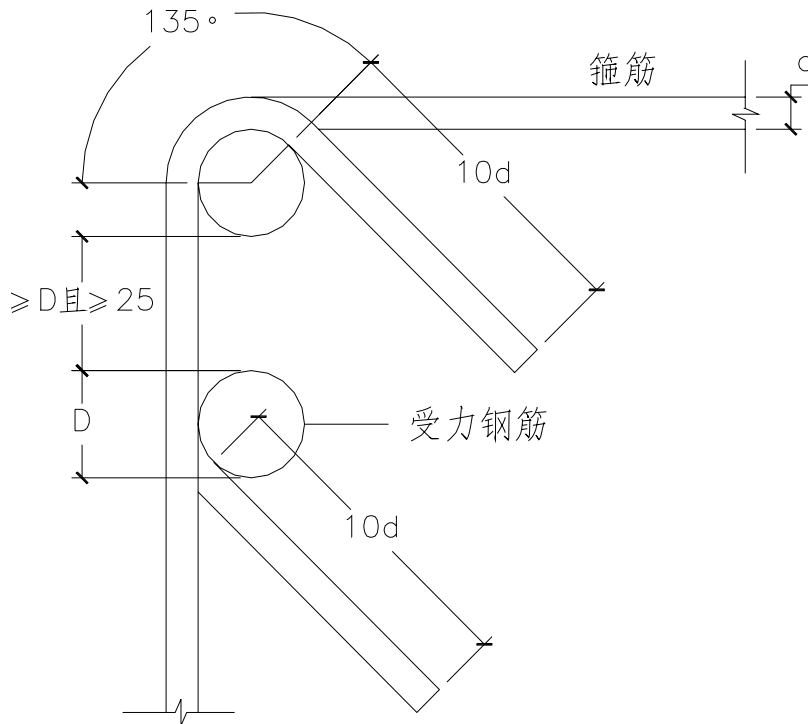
I 级钢筋弯钩尺寸示意图 2
